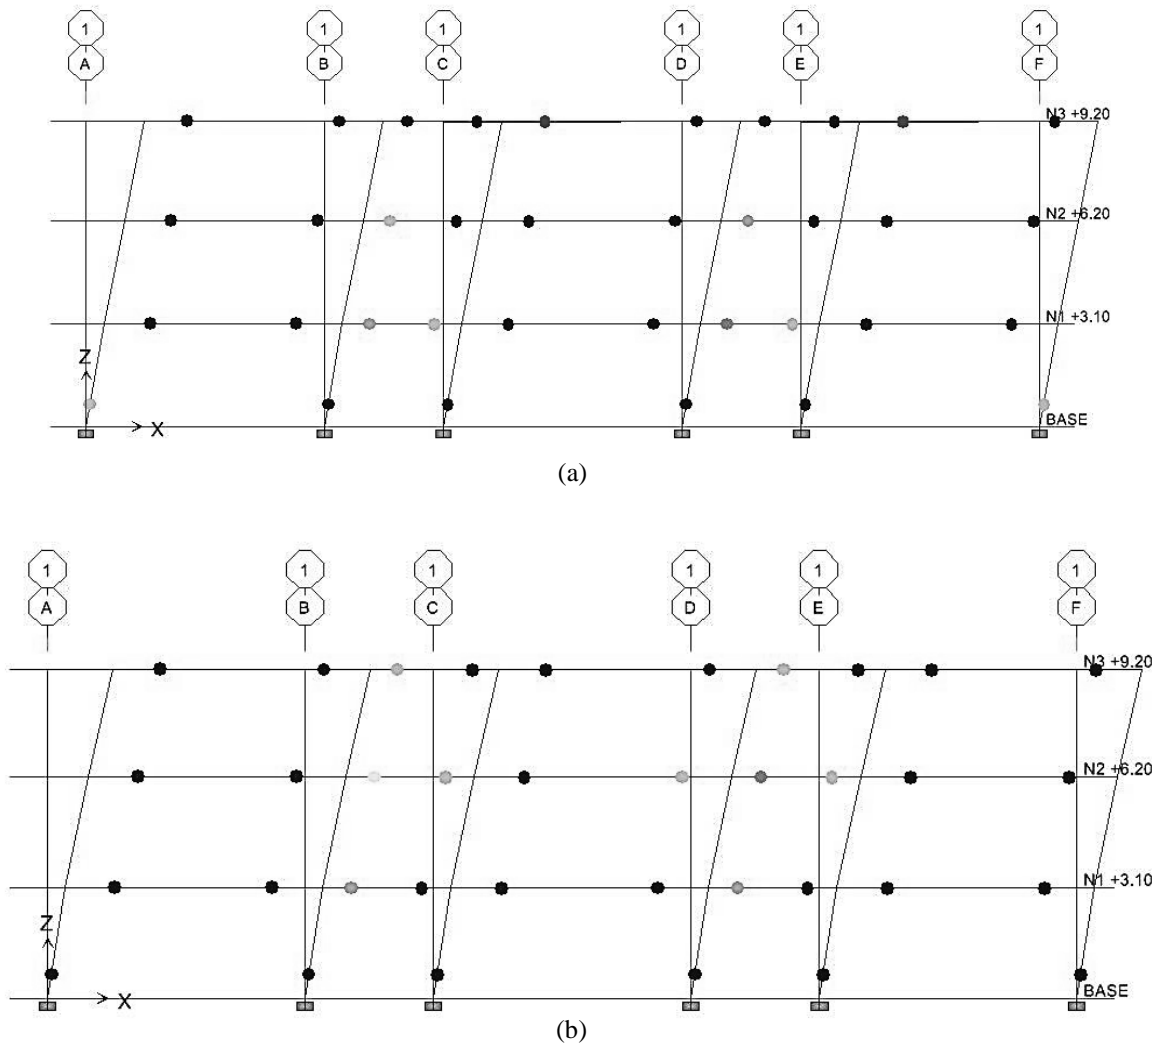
Mecanismo plástico de colapso para el Pórtico 3.1:
